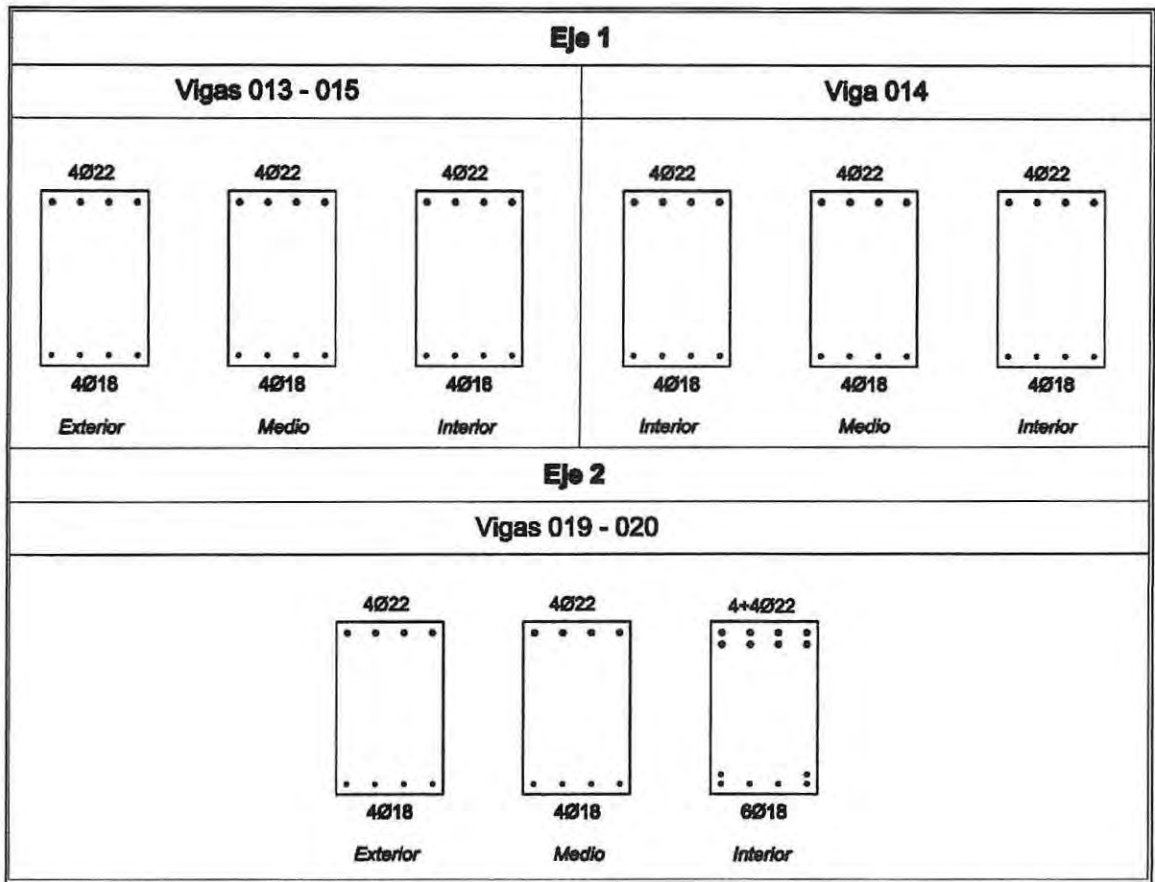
Armadura a flexión de vigas en estructura mixta, Ejes 1 y 2.
